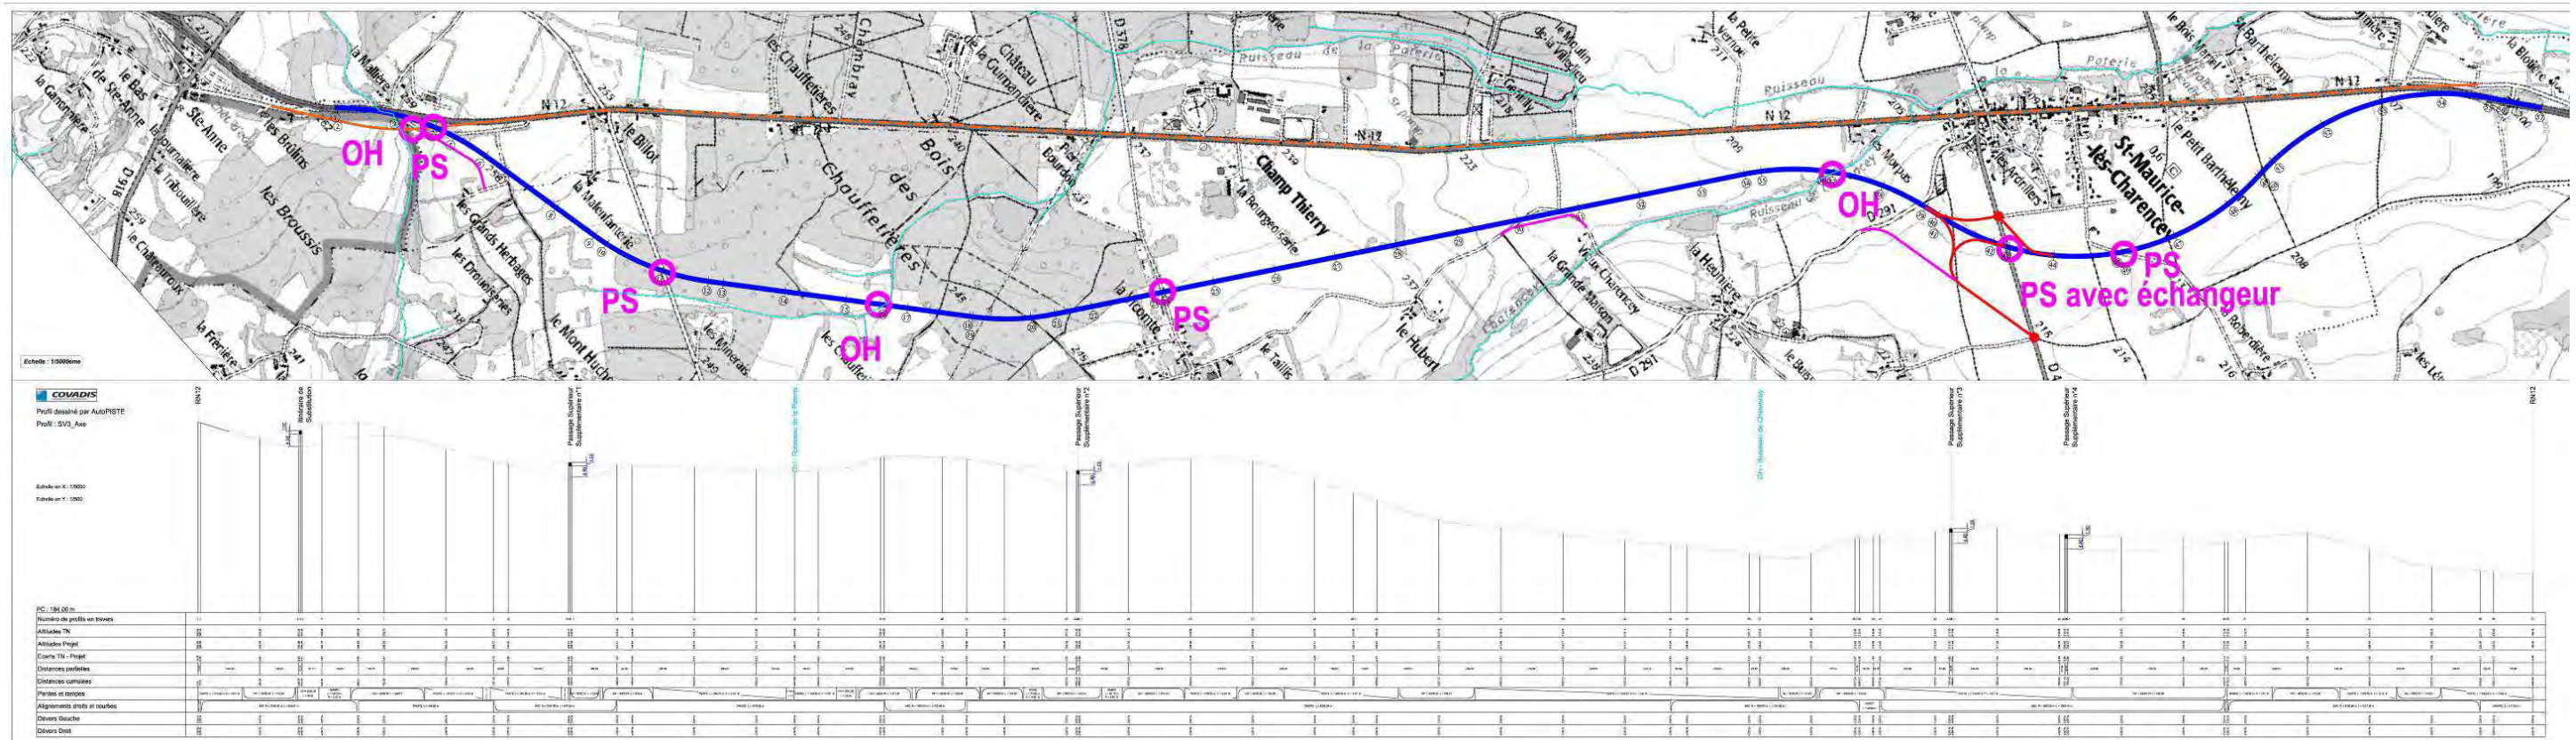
Tracé en plan et profil en long de la variante 3 (source : IGN / SEGIC)
